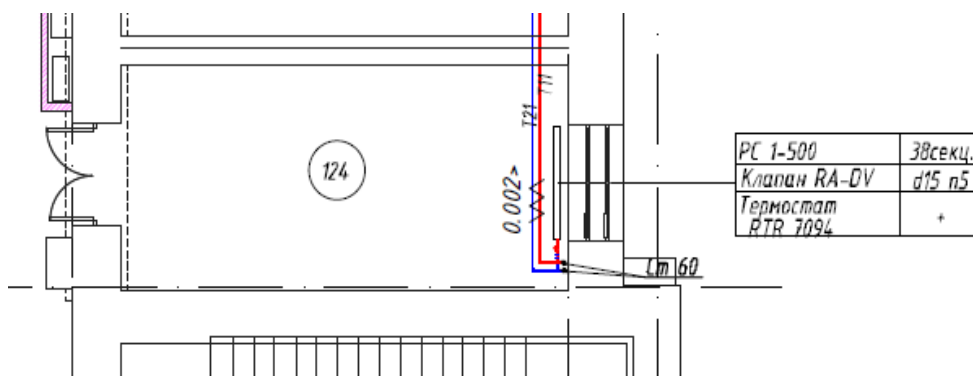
Фрагмент плана помещения с инженерными системами отопления
